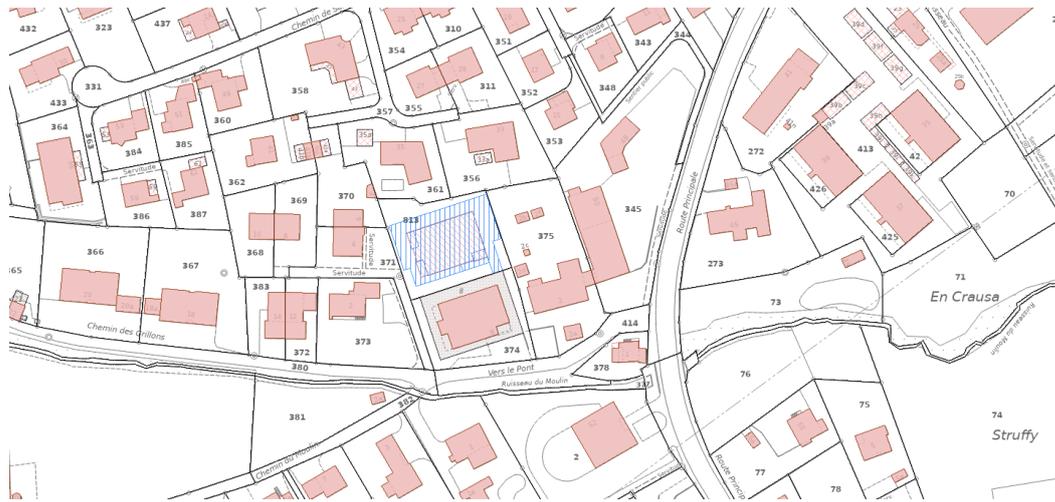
Extrait du plan du bâtiment projeté (Etat de Fribourg, 2024).
